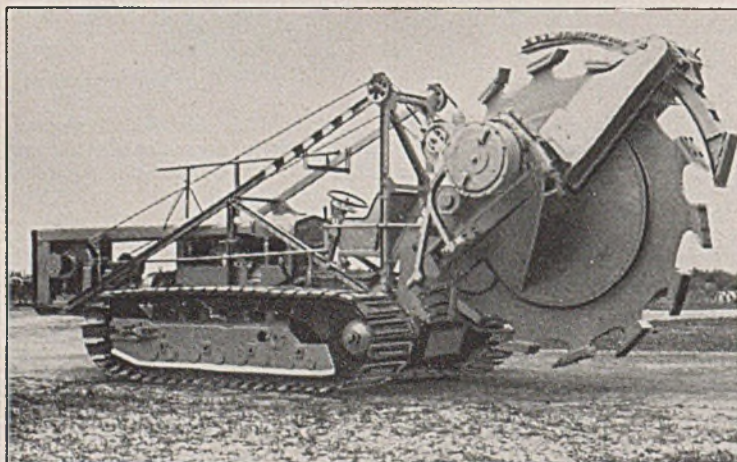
ATG-Grabenfräser mit gehobenem Fräsräd.
